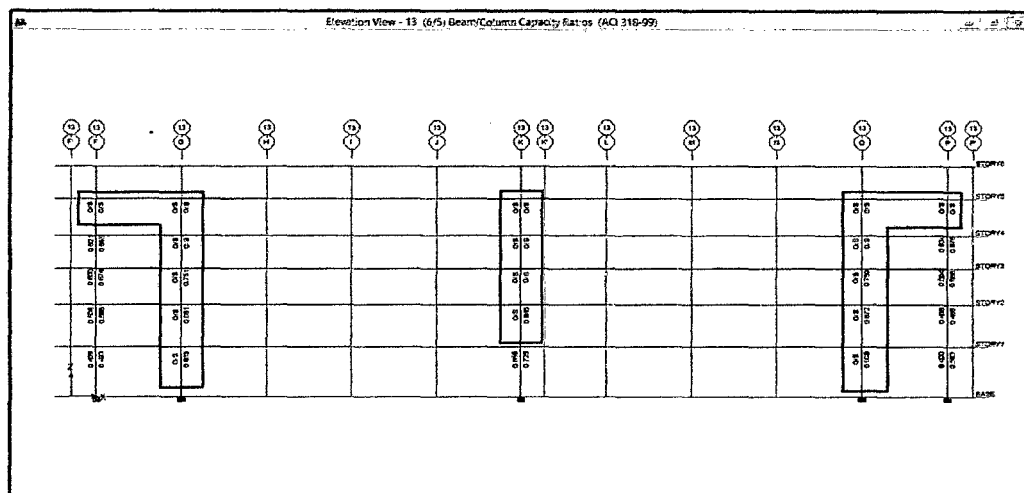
Ubicación de Fallas en columnas – Eje 13
